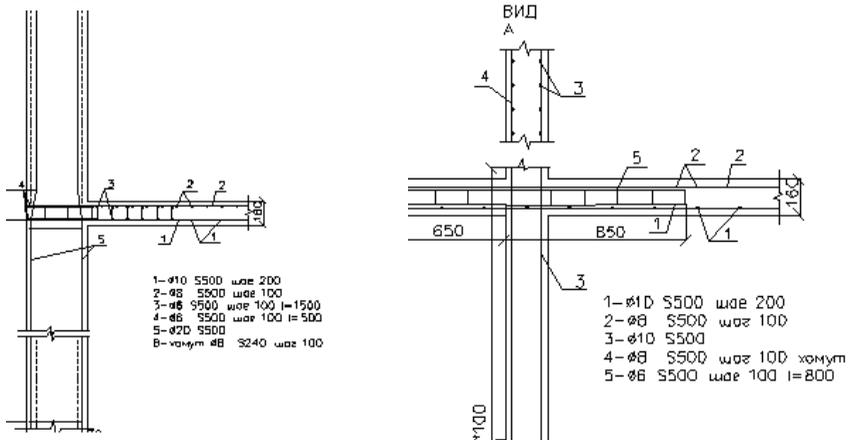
Узлы сопряжения плиты перекрытия с вертикальными конструкциями
